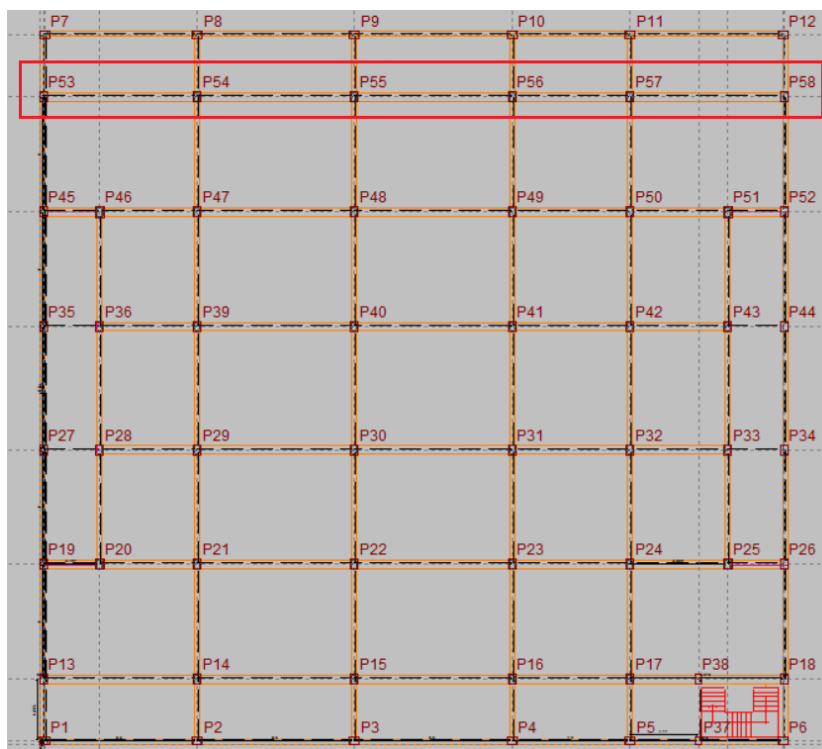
Vista en planta de la disposición de vigas y pilares de Cype (Ref. [5])
